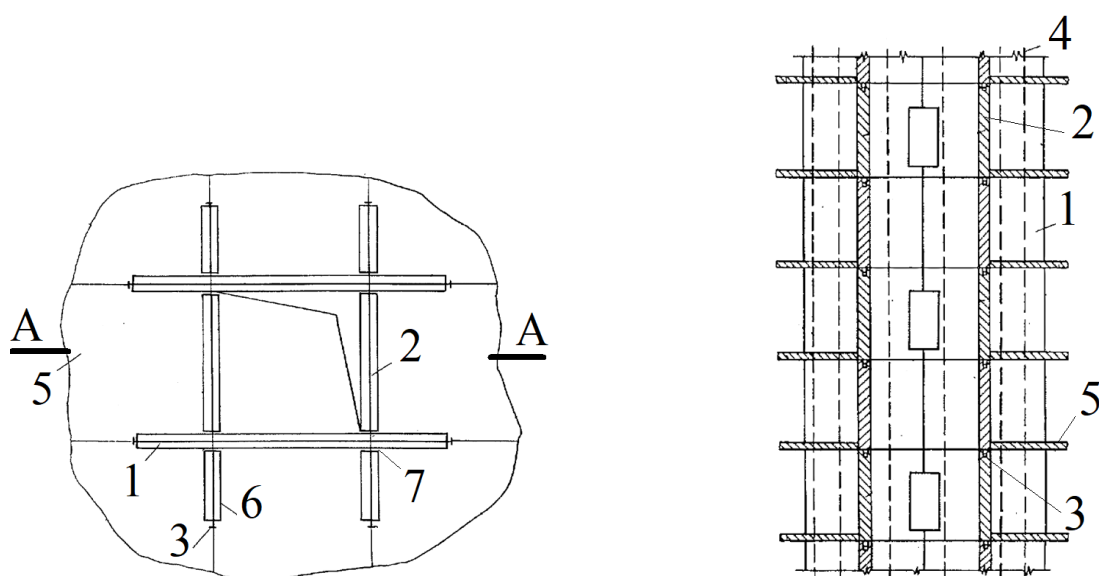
Многоэтажное сейсмостойкое здание: 1, 2 – стеновые панели; 3 – горизонтальная напрягаемая арматура; 4 – вертикальная напрягаемая арматура; 5 – перекрытия; 6 – выступающие части панелей; 7 – внешние углы
